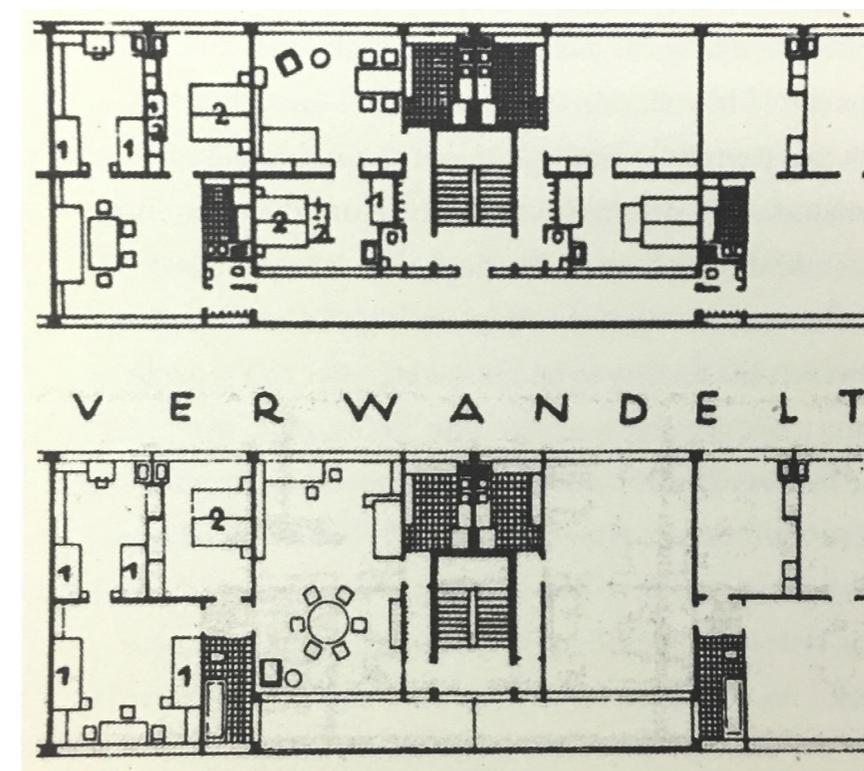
“Plans showing separated (above) and joined (below) units, In the latter case the balcony can be used as a private space.” (Schneider & Till, 2007, p. 142)
